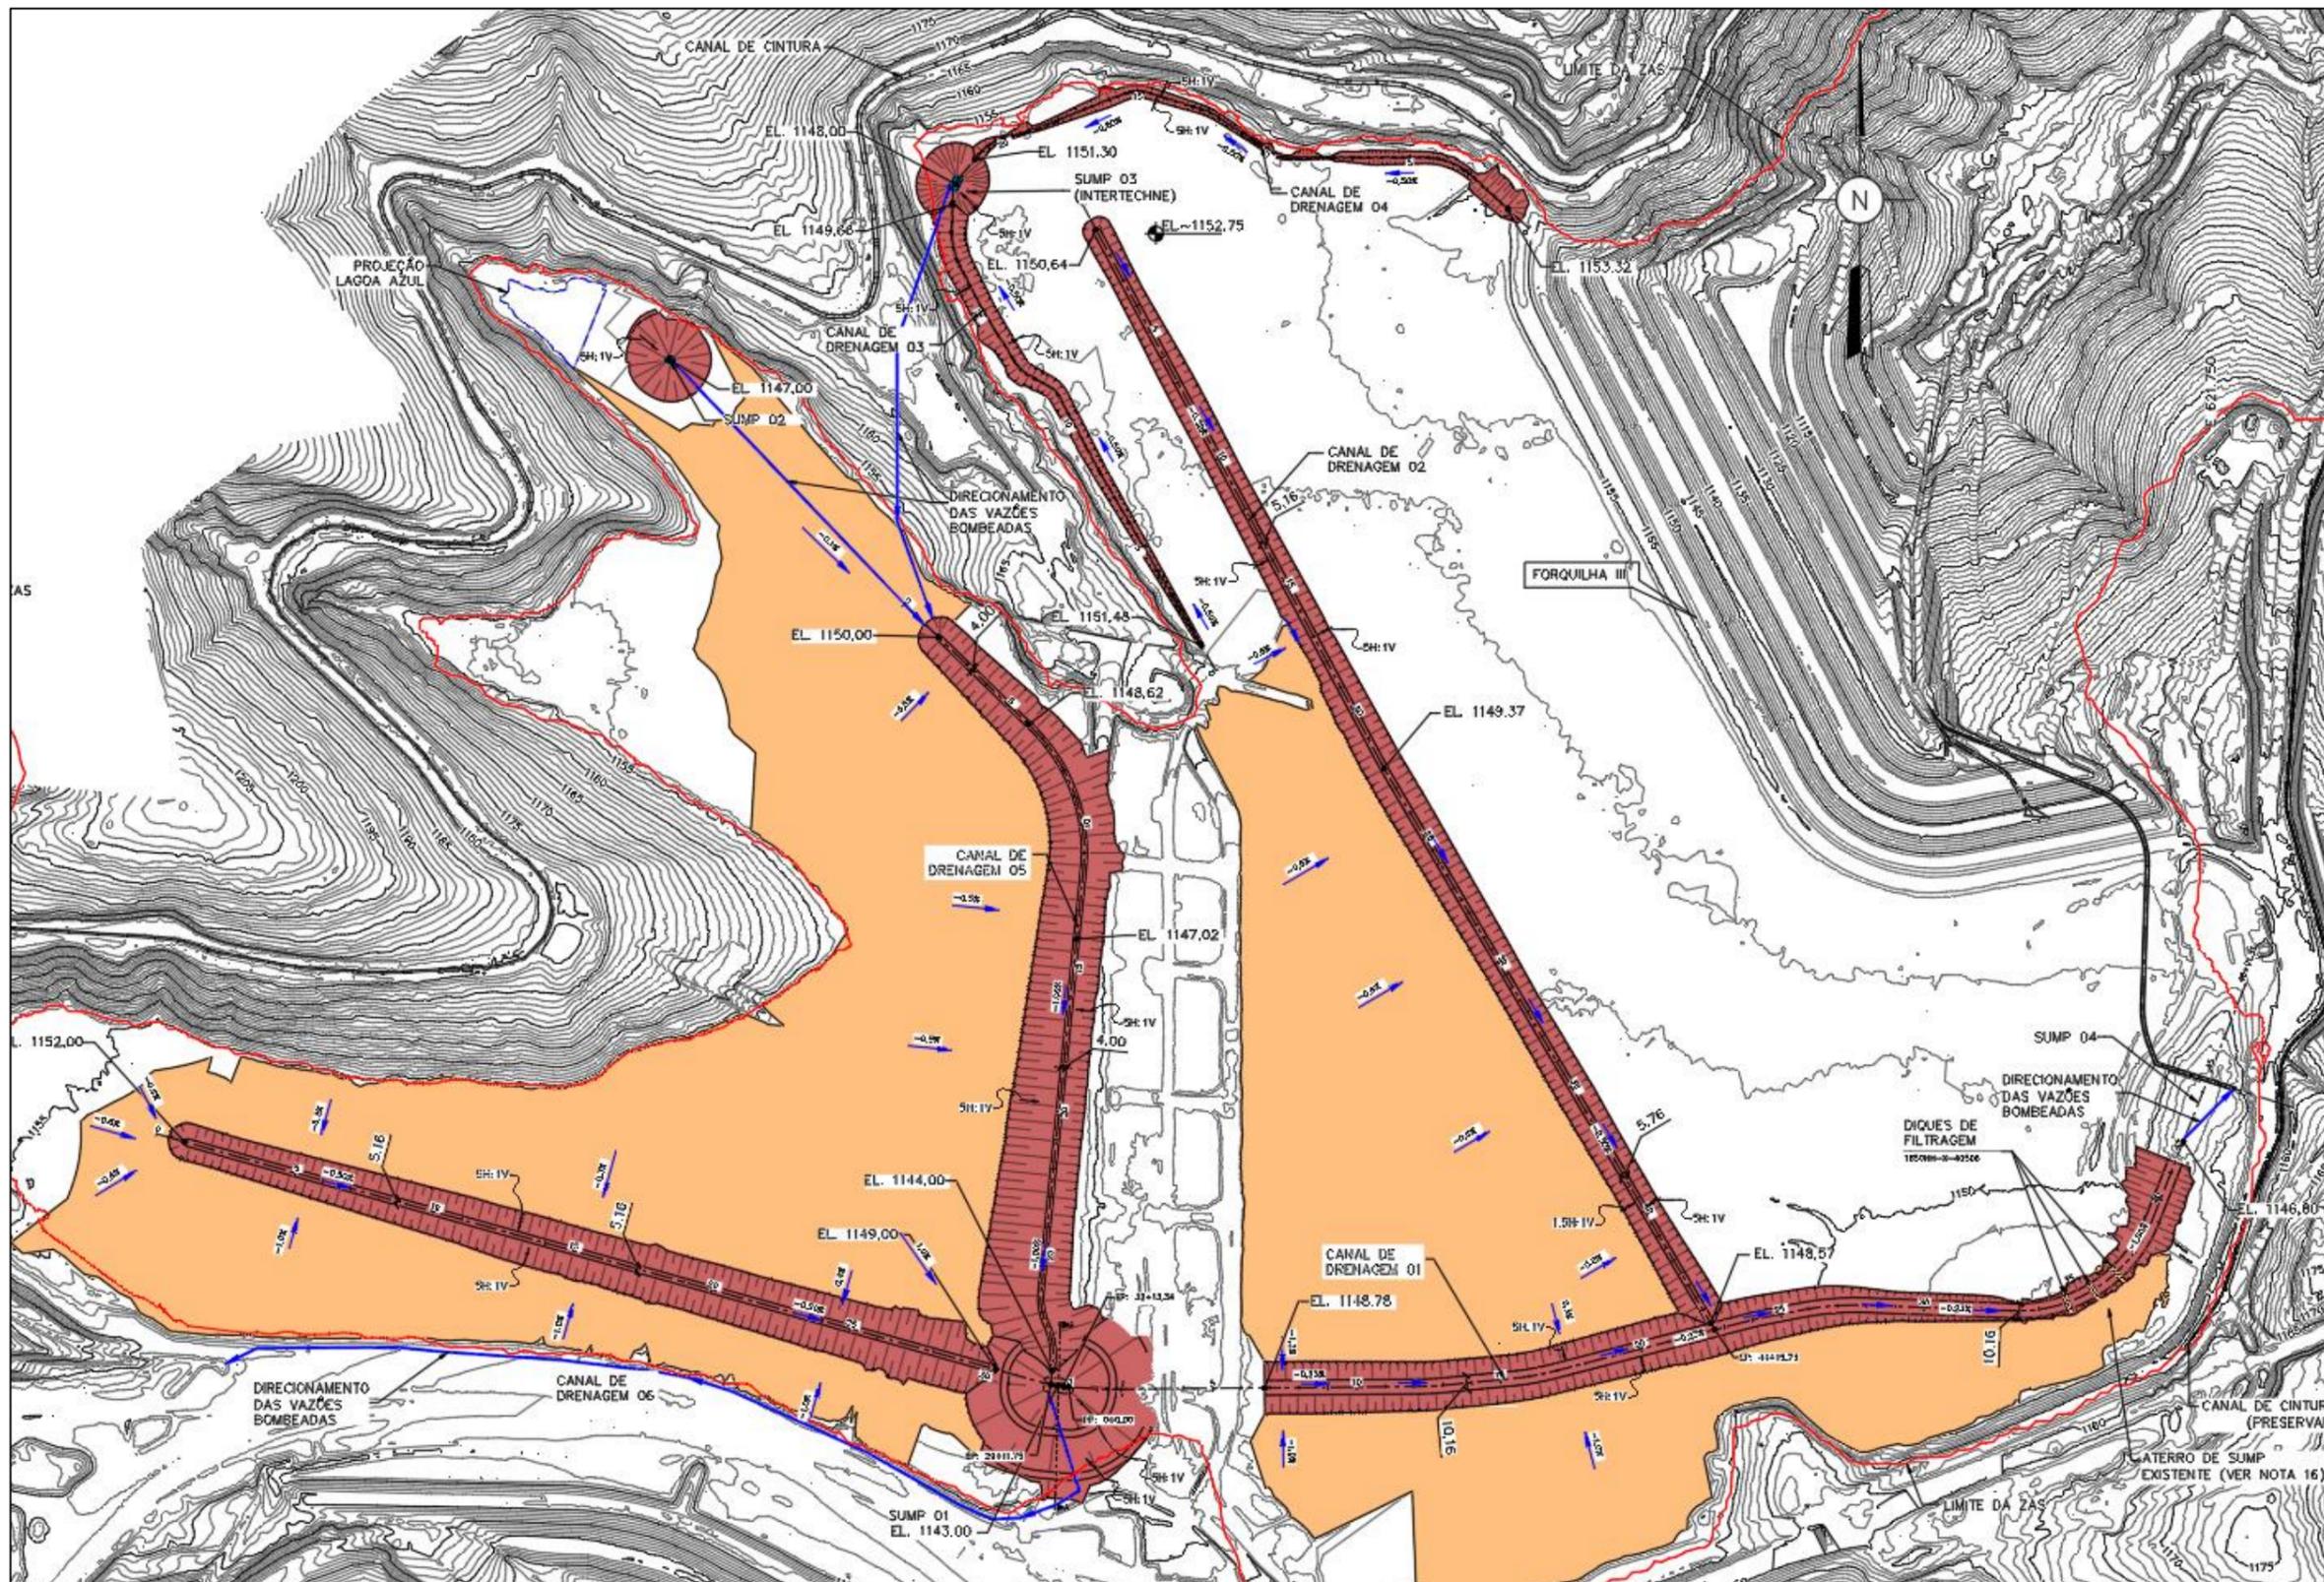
Arranjo geral do plano de chuvas 2024/2025, Projeto INTT – Obras em fase final de execução.
